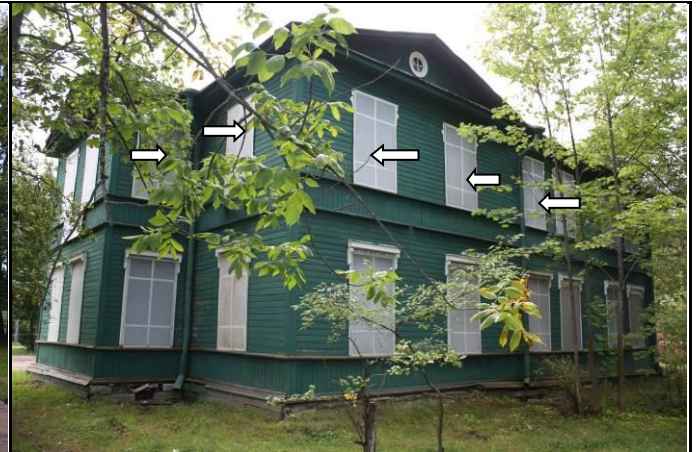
Фасад здания (вид с улицы). Окна оцениваемой
